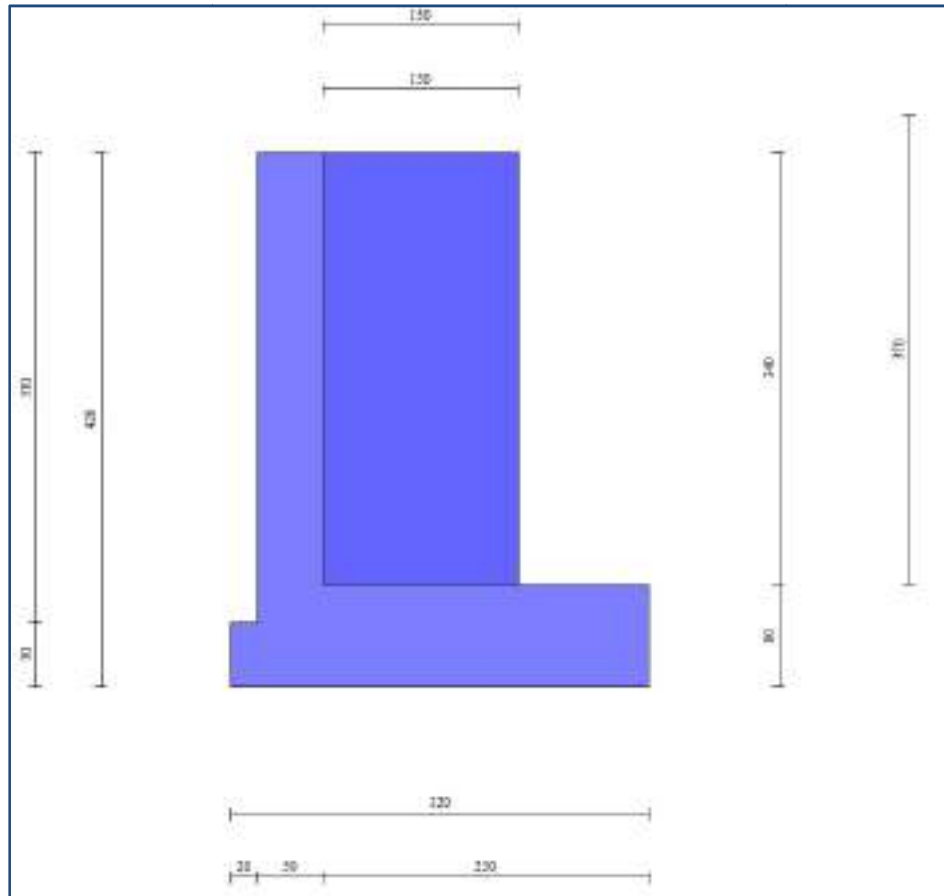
Sezione trasversale tipo 1 in Aztec
